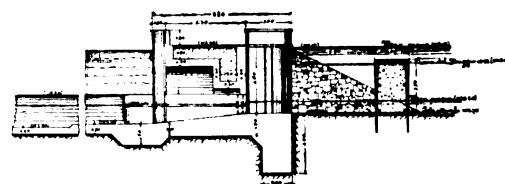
Sezione trasversale secondo a b della fig. 4 (Scala 1:500).
